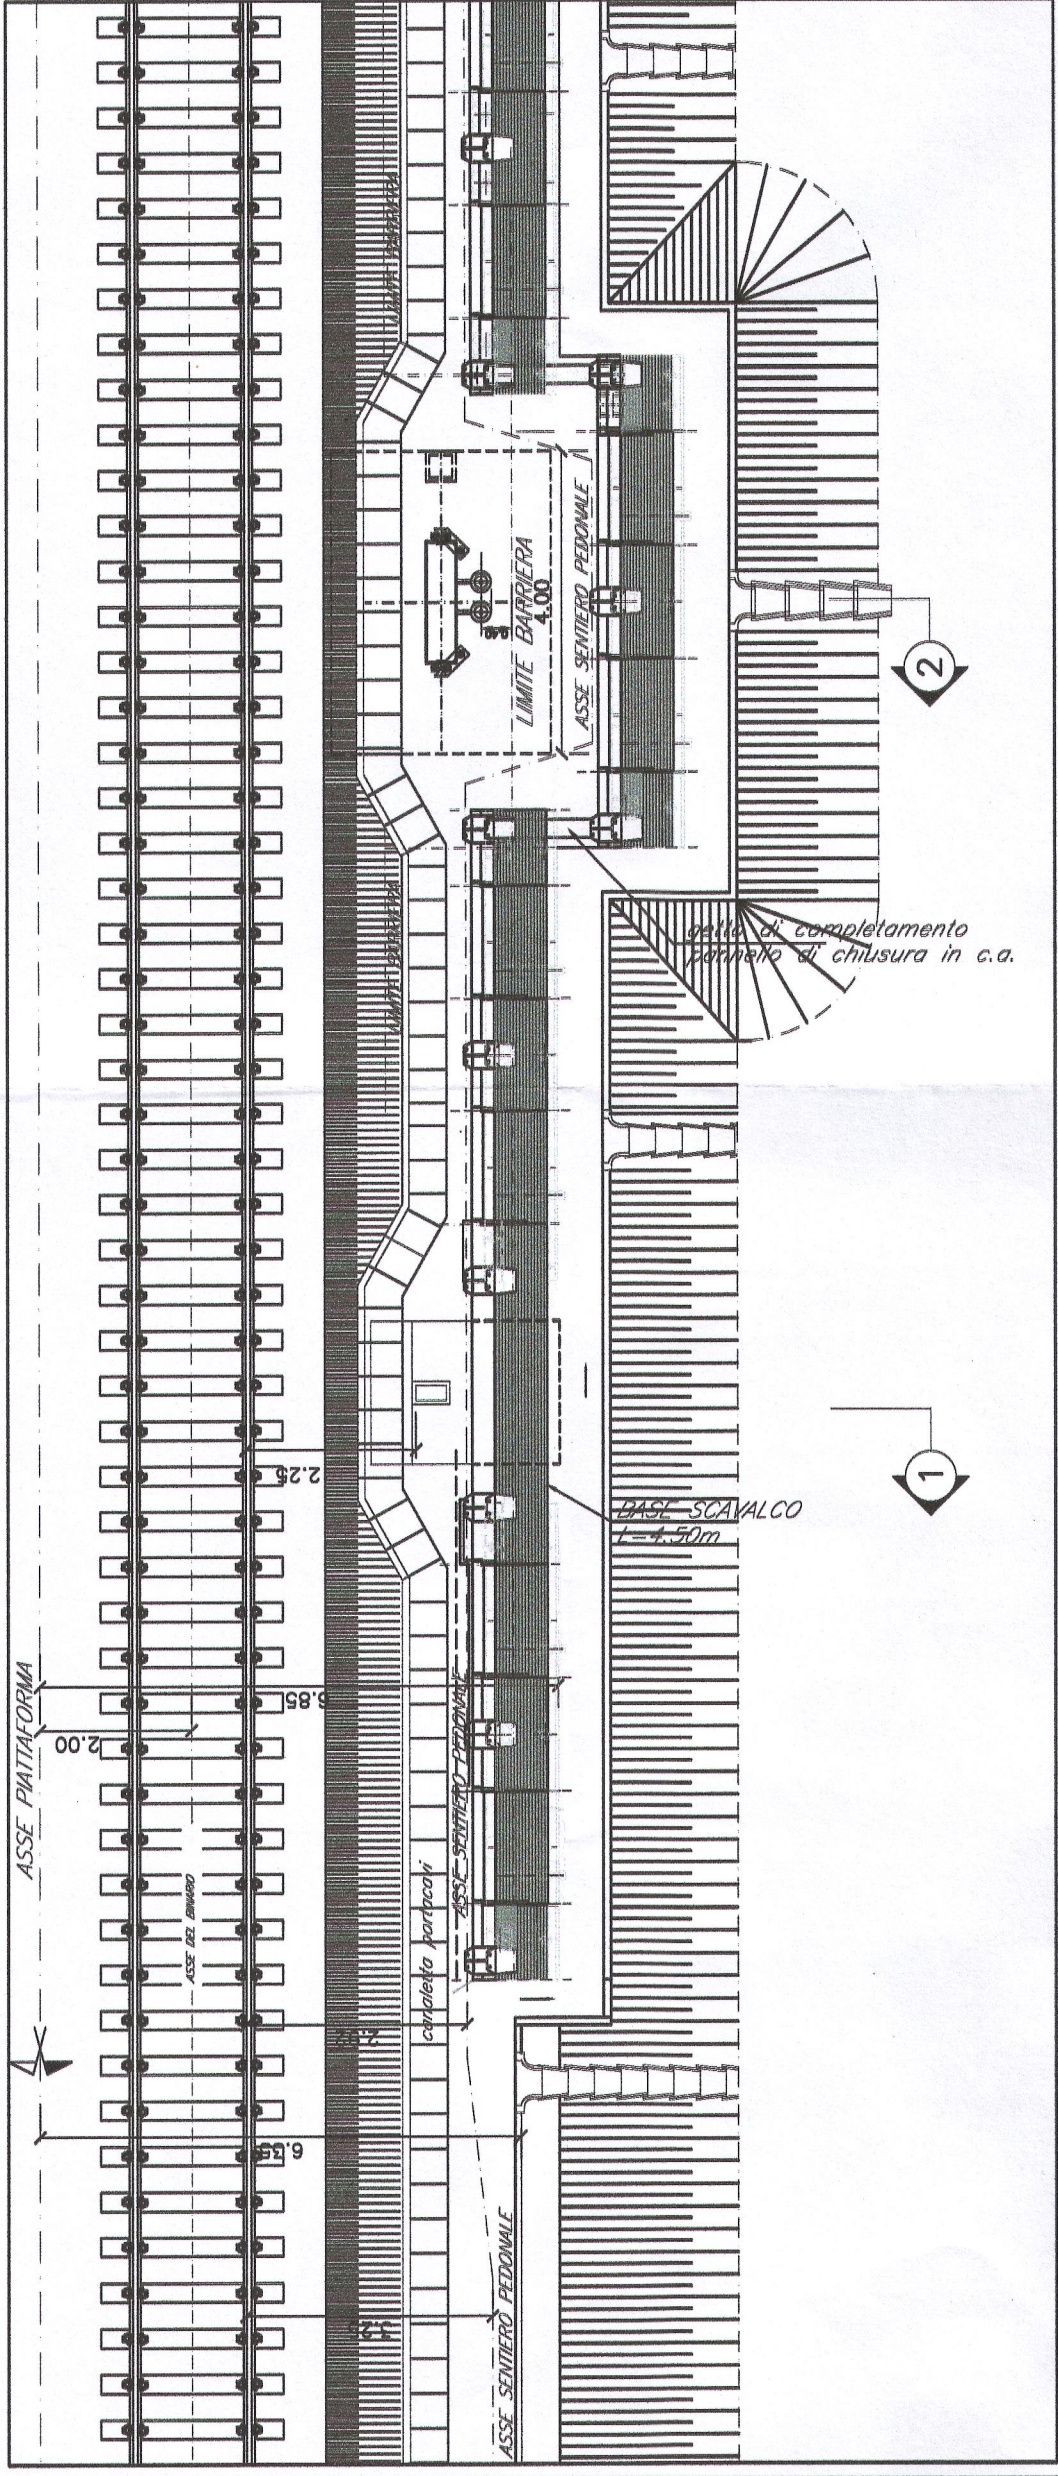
Stralcio planimetrico delle barriere fonoassorbenti
